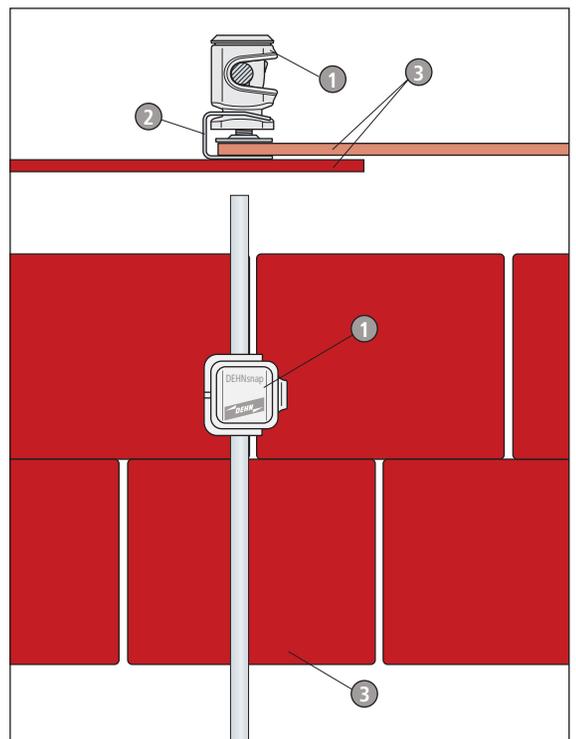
Soporte de conductor de tejado PLATTENsnap para construcciones solapadas.
